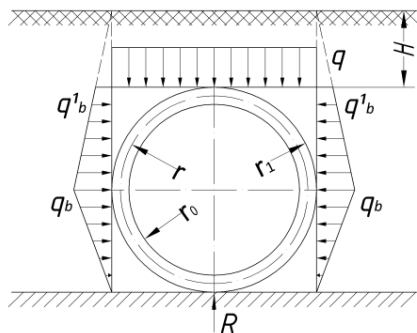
Расчетная схема давления грунта на трубопровод
